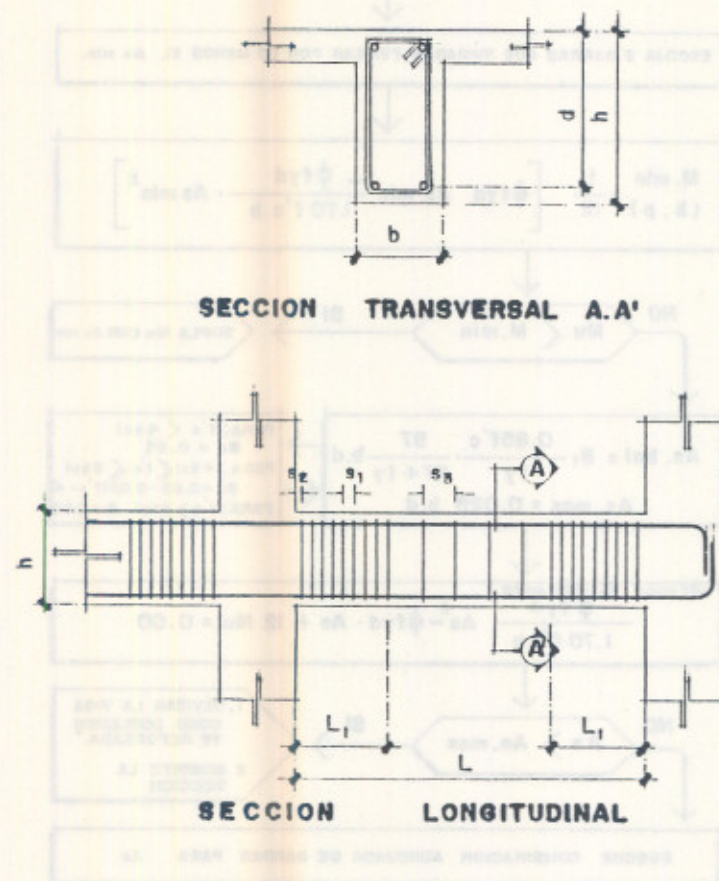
Requisitos para el refuerzo transversal de vigas
